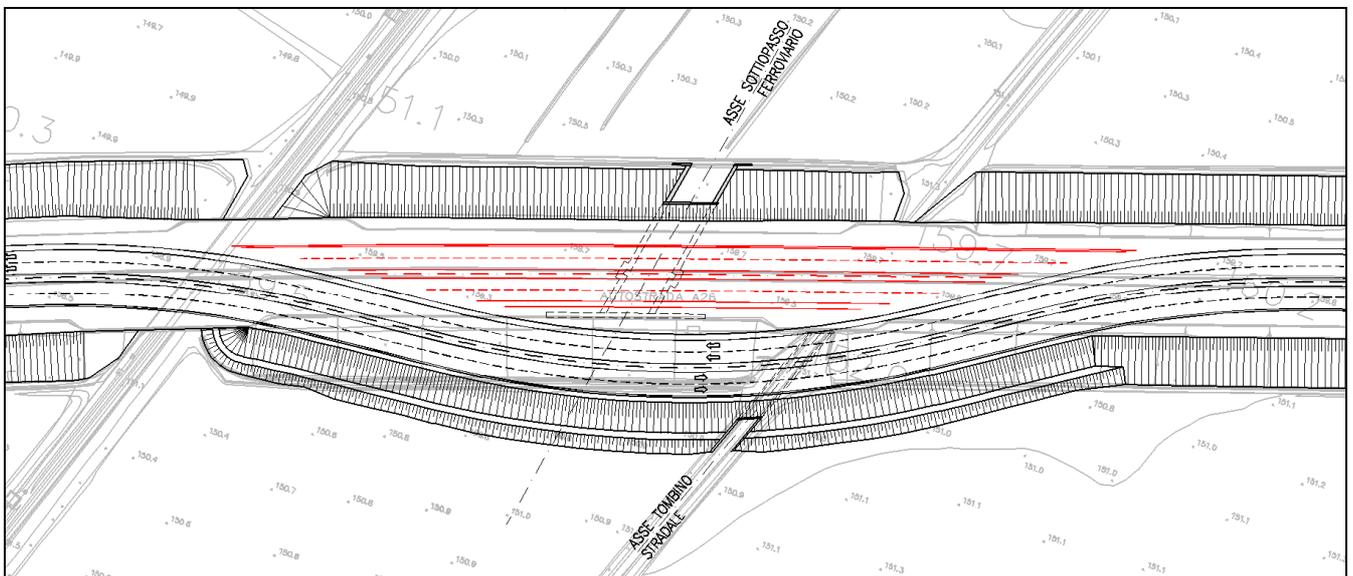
Planimetria fasi realizzative dell'opera. Fase 3
